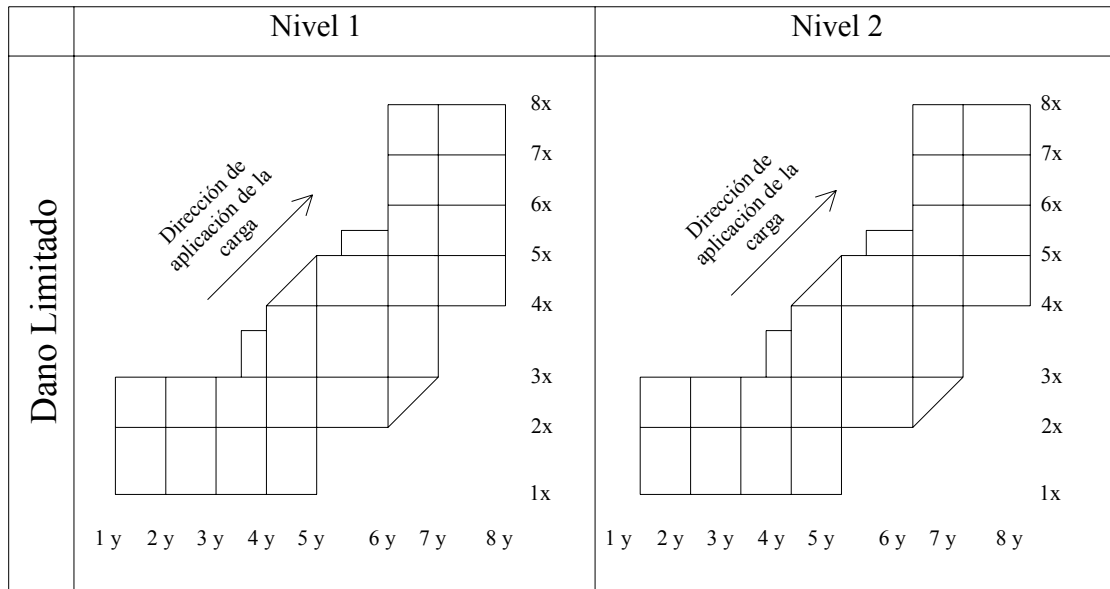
22 Vista en planta Niveles 1 y 2, para E.L. de D.L.
